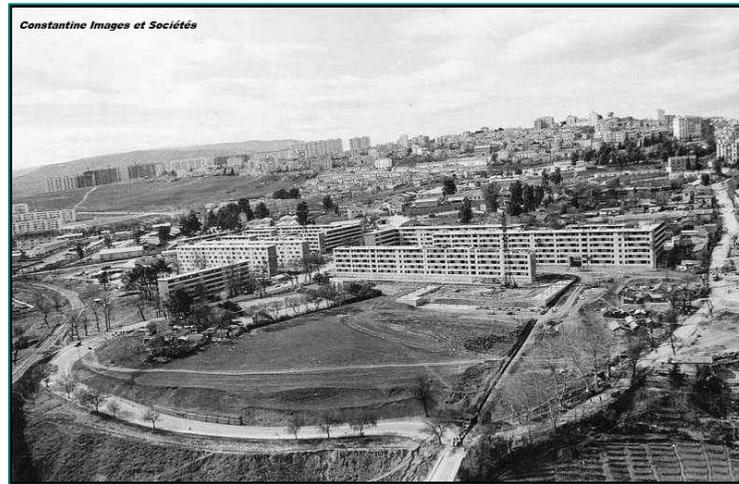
Constantine : Chantiers de construction, au premier plan, la Cité de Chasseurs, en haut à gauche madame Roc et les CILOC. Photo de la fin des années 50.
